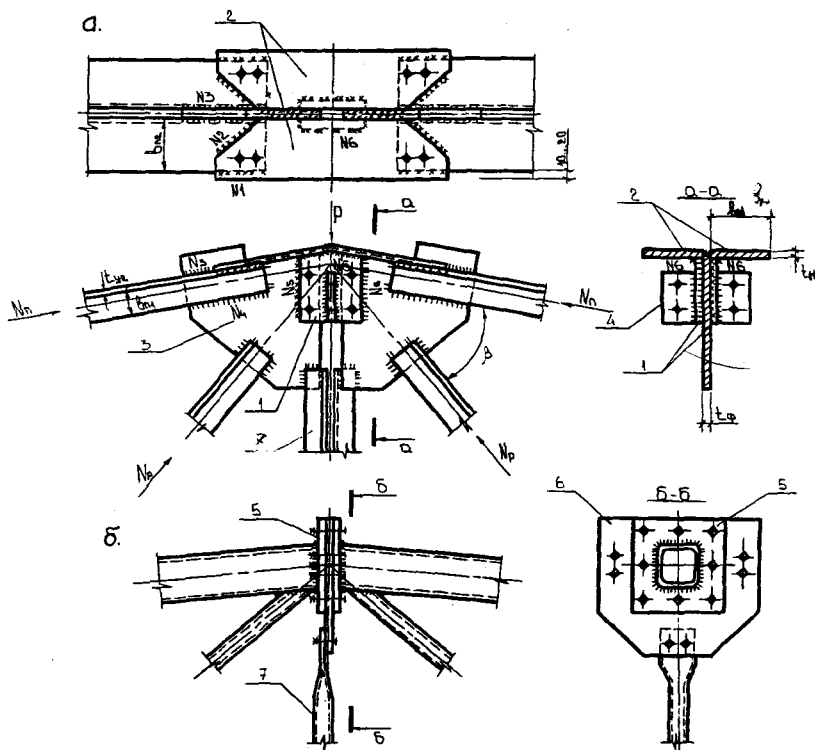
Монтажные узлы ферм: а — из спаренных уголков; б — из прямоугольных труб; 1 — вертикальные накладки; 2 — накладки по верхнему поясу; 3 — фасонка; 4 — детали для крепления связей; 5 — фланец; 6 — прокладка; 7 — стойка
